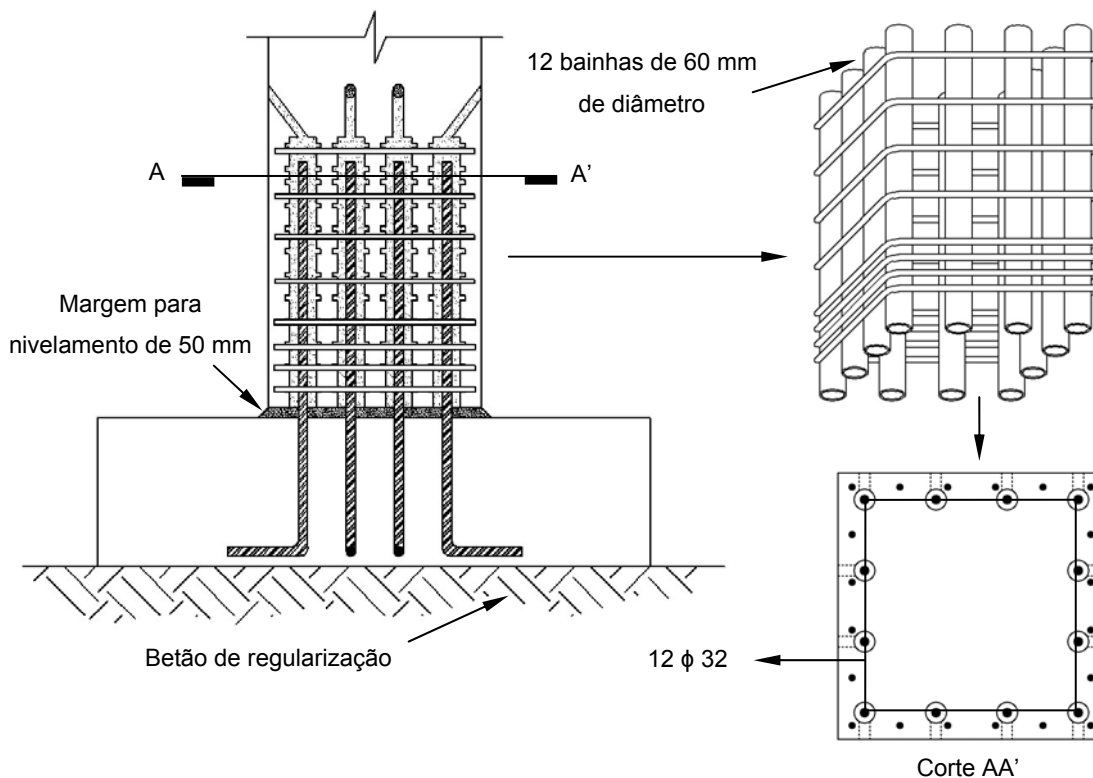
Ligação pilar – fundação através de bainhas preenchidas com grout
